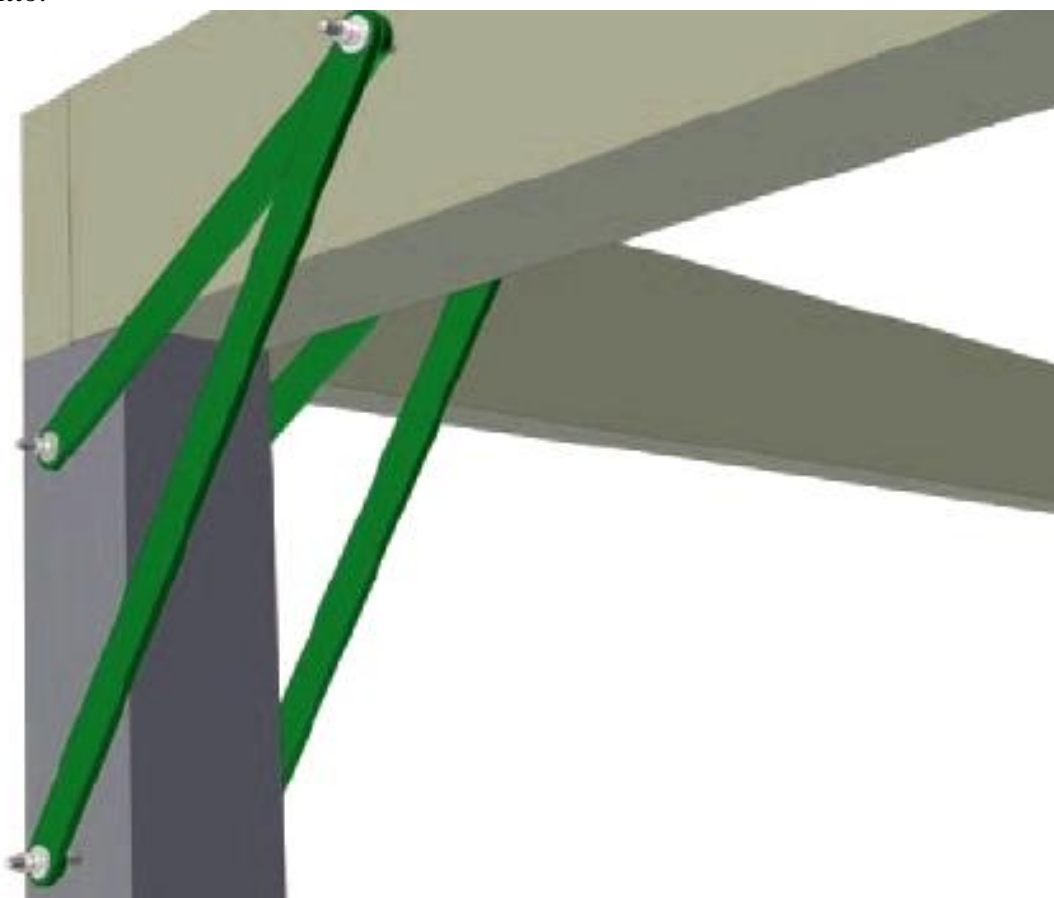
SICURLINKTM - Connessione trave-pilastro
